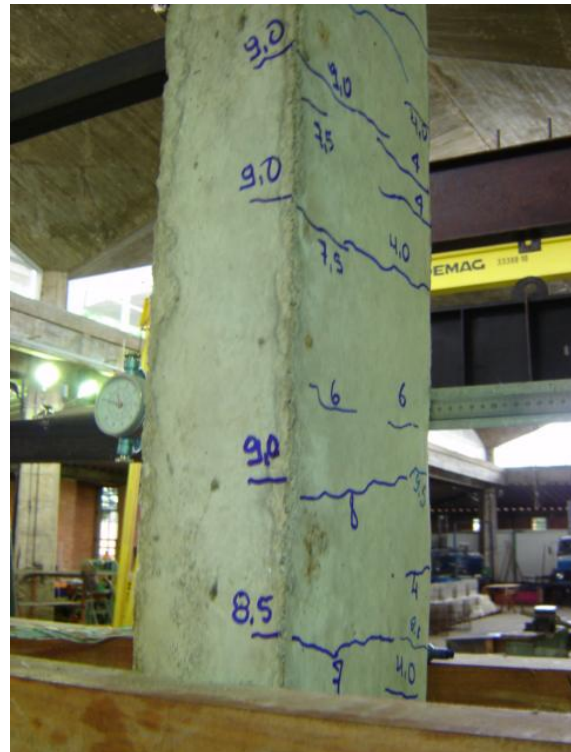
Fissuras do pilar PFN 60-3
